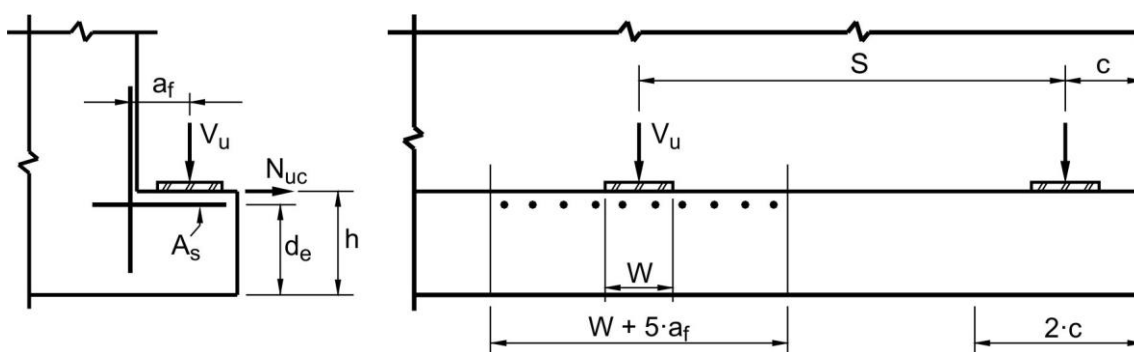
Diseño de los resaltos horizontales para flexión y fuerza horizontal
